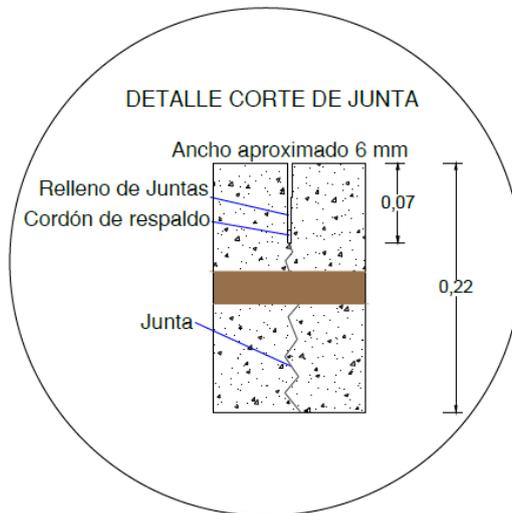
Detalle de corte de junta. Elaboración Propia
